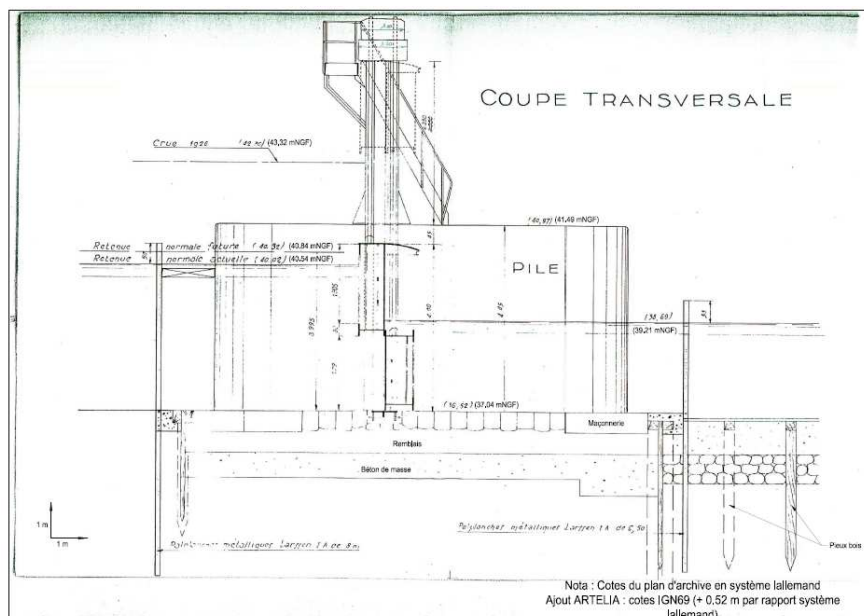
Coupe sur pertuis existant pour l'exécution des travaux de 1968 – Cahier de plans technique ARTELIA
